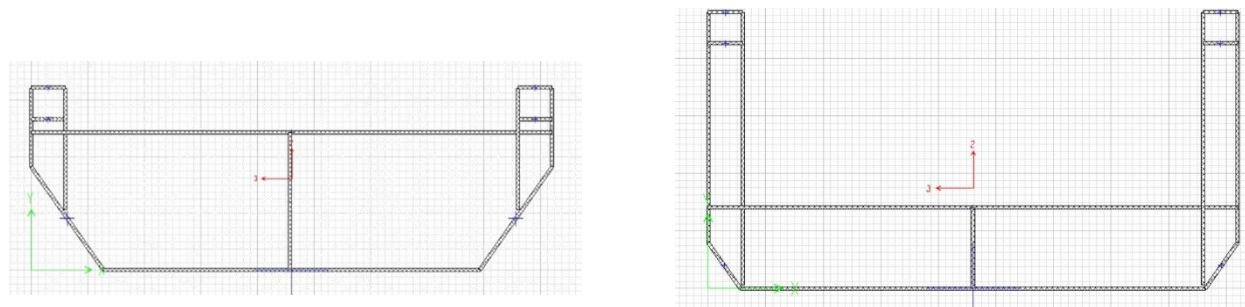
Secciones tipo pasarela 1, derecha sección centro luz e izquierda sección en el apoyo
